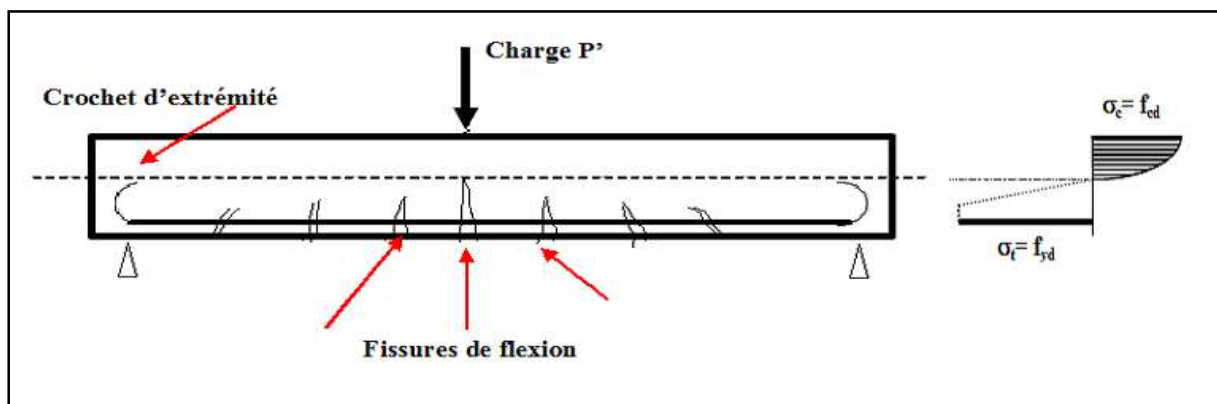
Mécanisme de ruine d'une poutre en béton armé
